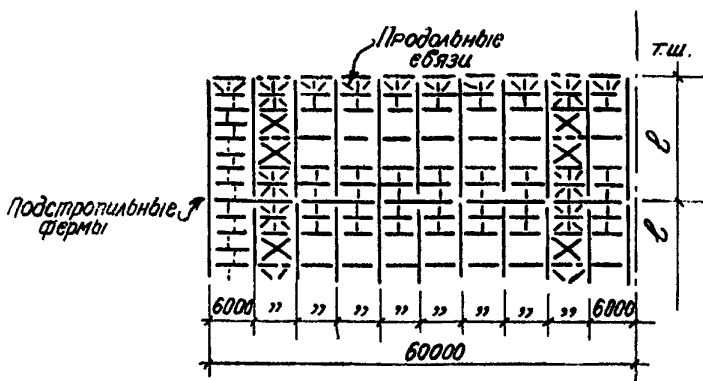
Схема продольных связей по верхним поясам ферм в покрытии с подстропильными фермами (в зданиях со смешанным каркасом)
